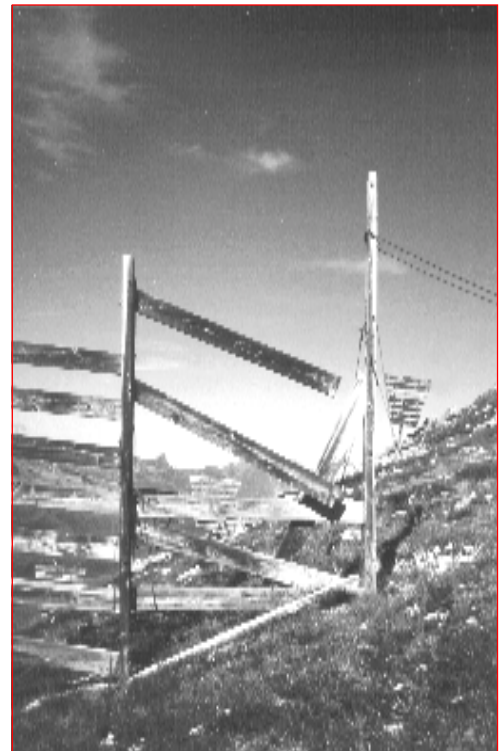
Planches de bois cassées sur une barrière de neige (photo Y. Queffélec, Cemagref).
